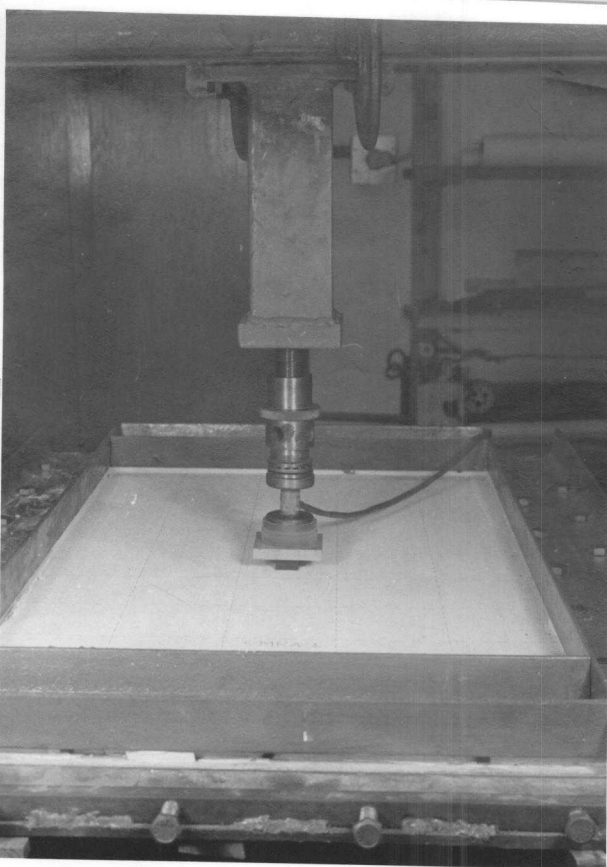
Aspectos do sistema de aplicação de carga por ocasião do ensaio de uma laje Tipo CA.
